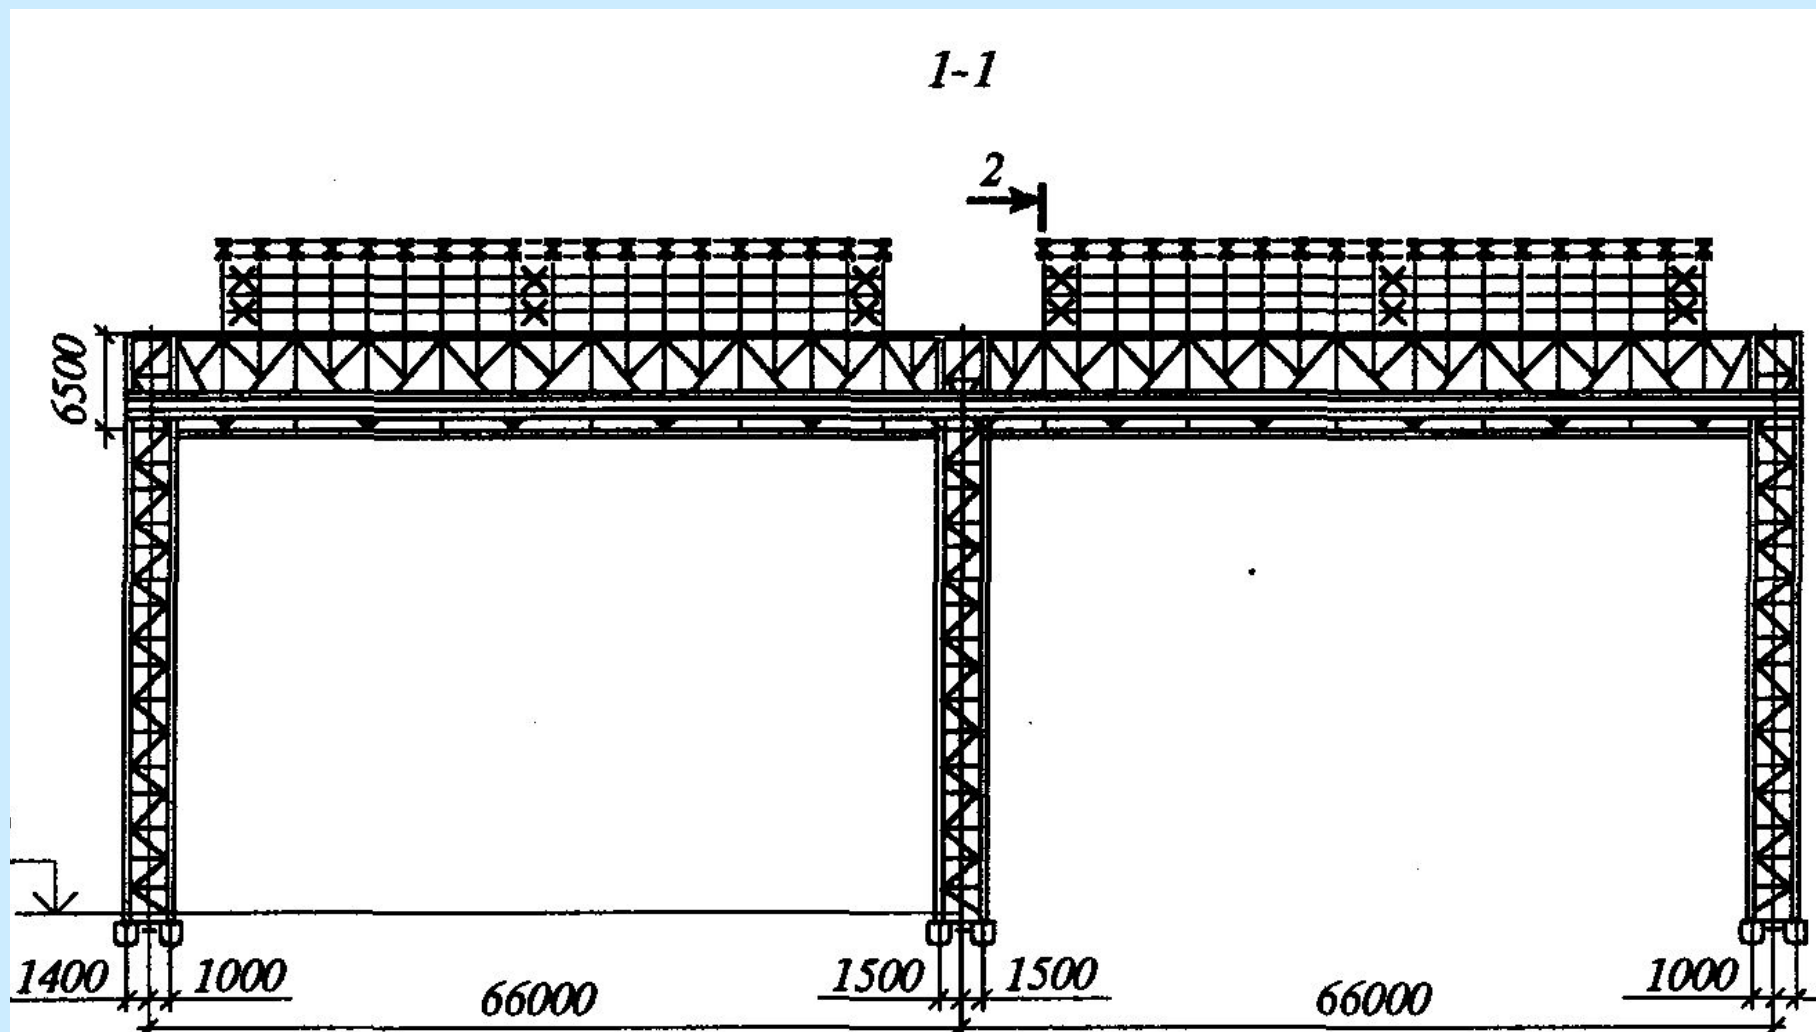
Двухпролетное здание пролетами 66 м с рамными несущими конструкциями
